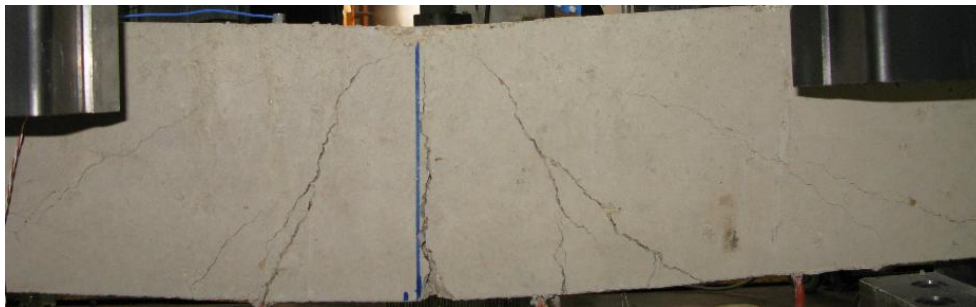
Faciès de fissuration de la poutre à la fin de l'essai (Leroux, 2012).
